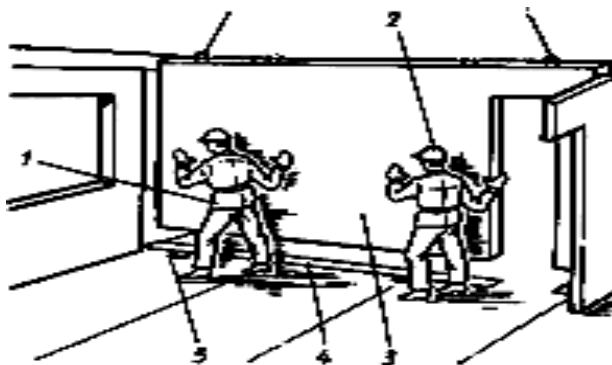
Схема установки сборного элемента: 1 – старший монтажник 4 разряда; 2 – монтажник 3 разряда; 3 – монтируемый элемент; 4 – основание под панель; 5 – геодезическая риска
